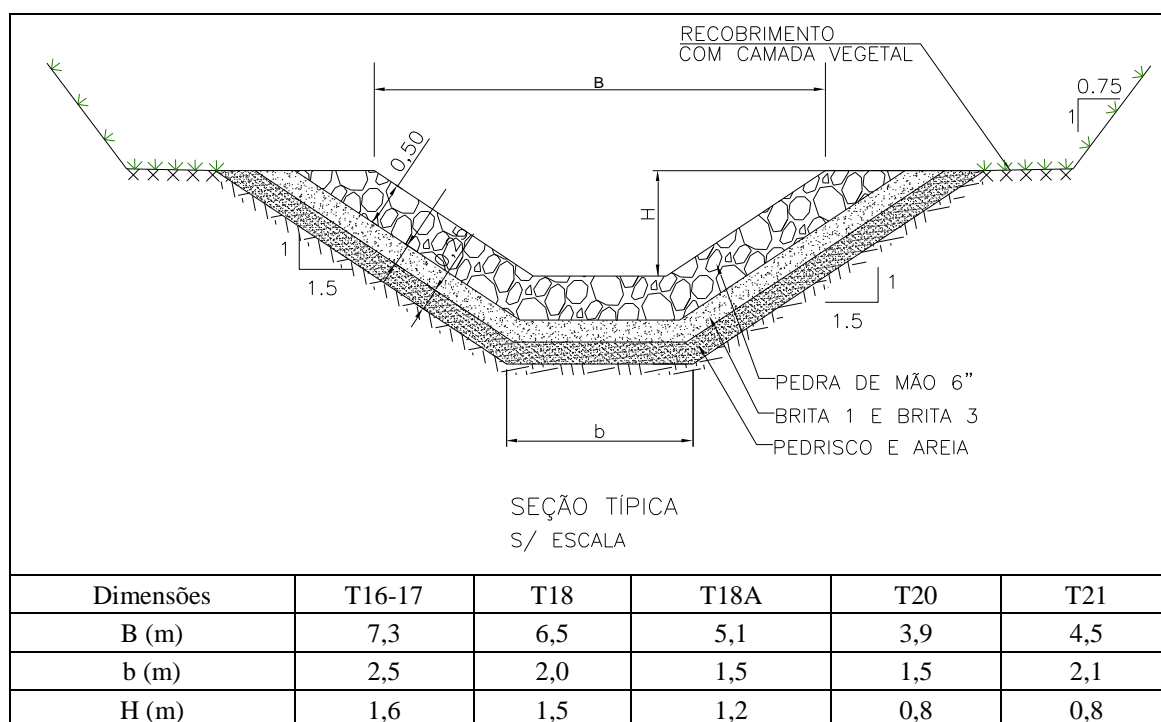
Alternativa 1 – Intervenção intermediária Seção típica do canal trapezoidal em enrocamento
